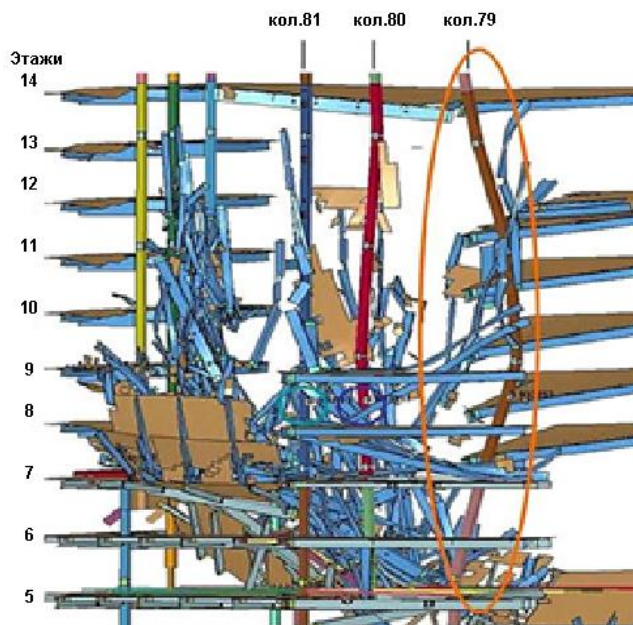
Схема этажей с колонной 79, предполагаемого места начала обрушения здания (NIST); с левой стороны указаны номера этажей
